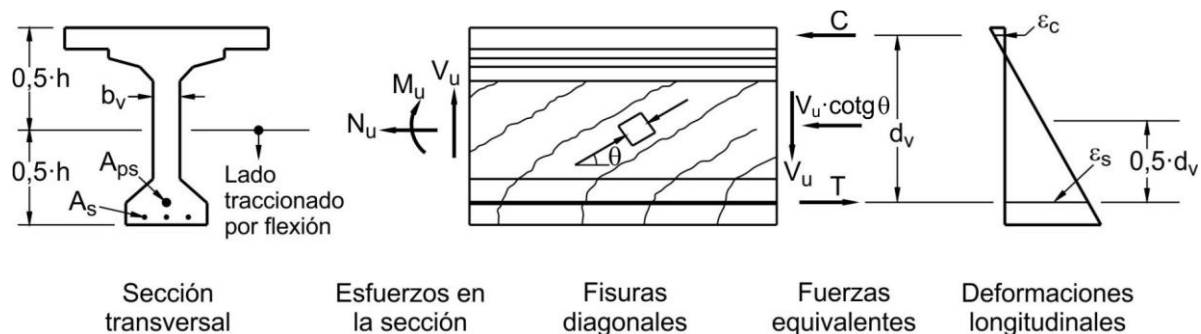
Parámetros de corte para una sección que contiene al menos la cantidad mínima de armadura transversal, $V_p = 0$
